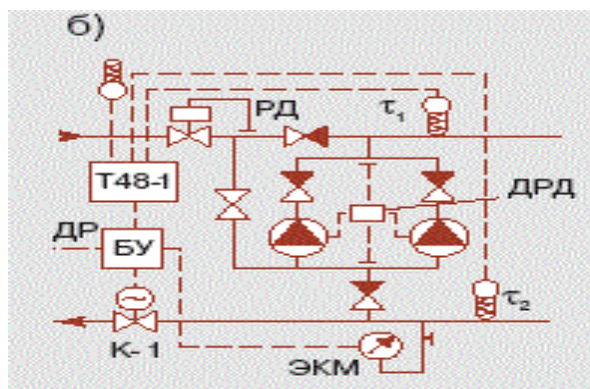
Фрагмент схемы при установке насосов на подающем трубопроводе
